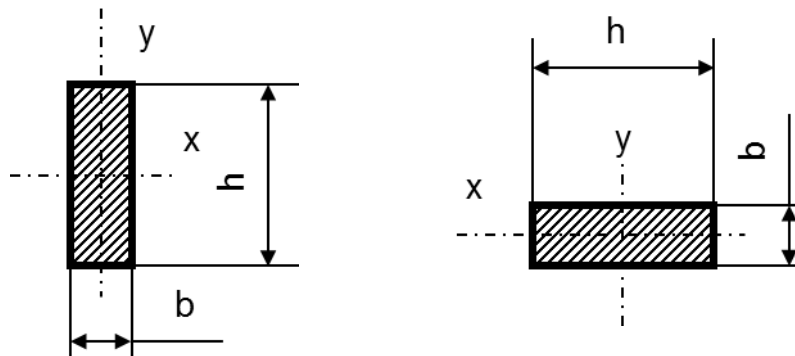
Размеры прямоугольного поперечного сечения балки
